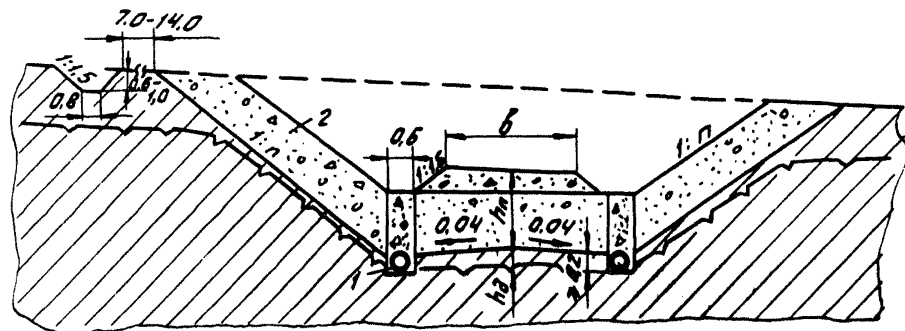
Схема выемки в льдонасыщенных вечномёрзлых грунтах:
